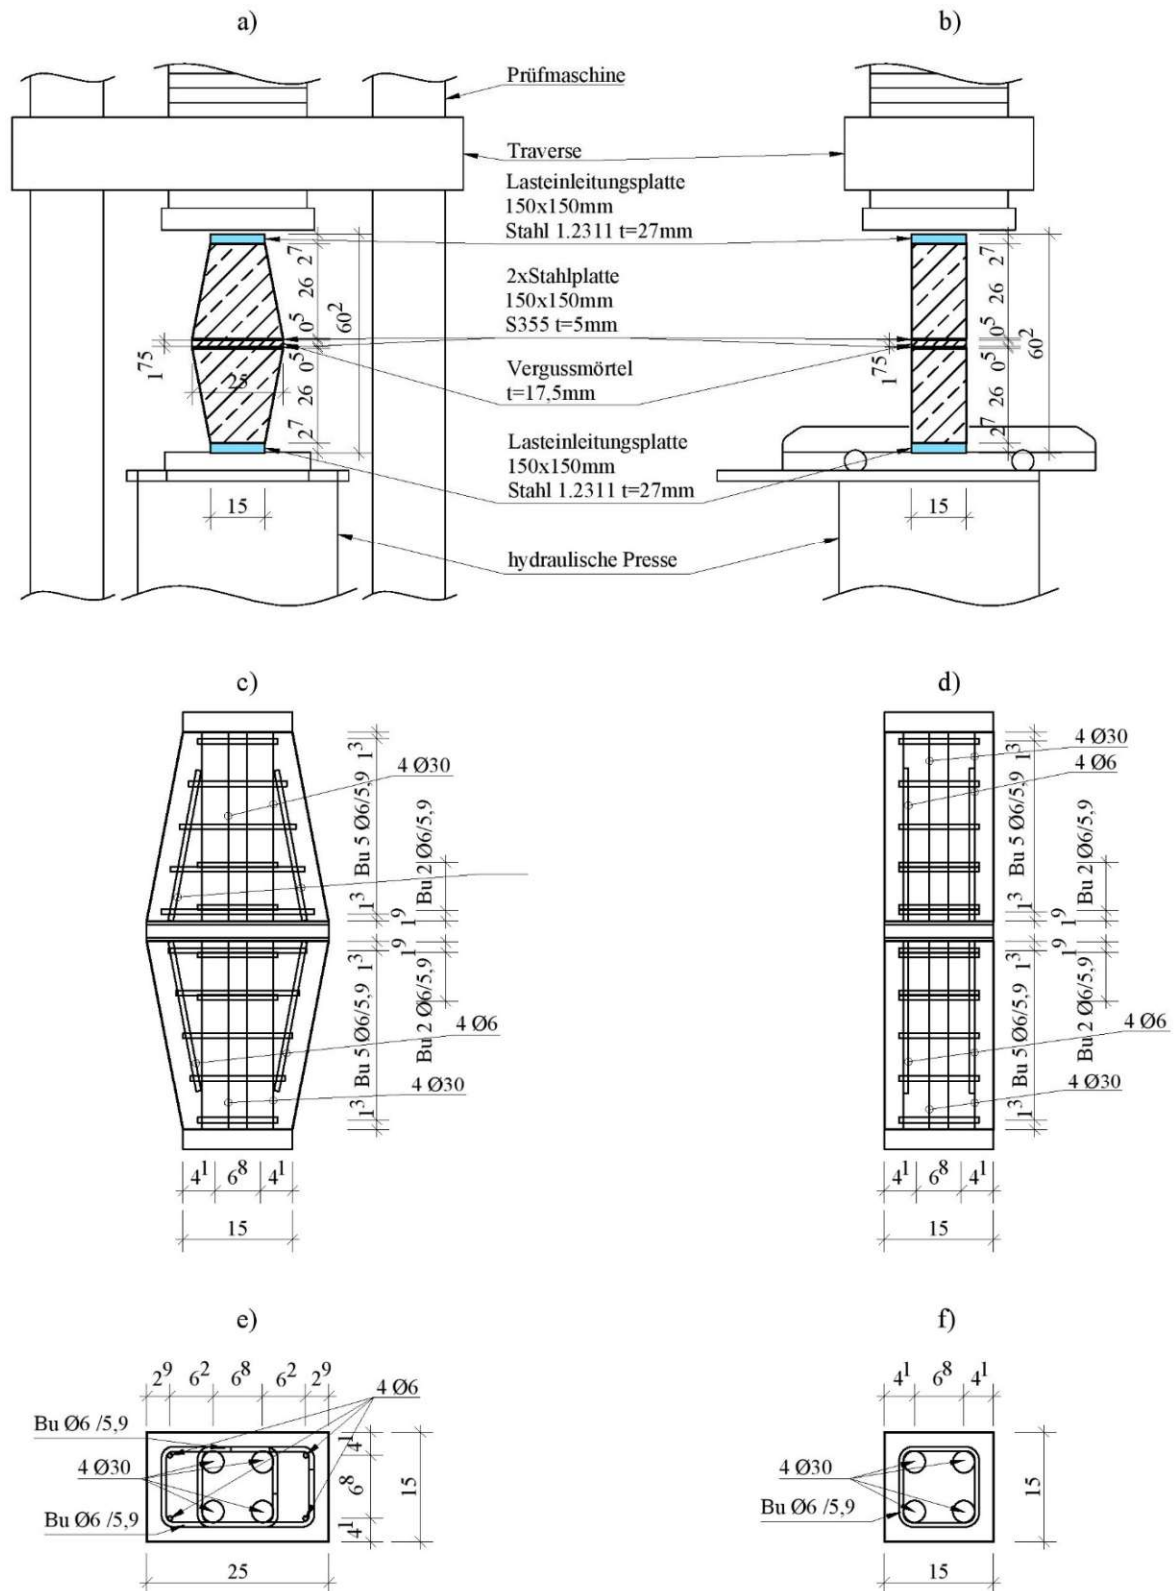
Stütze mit Stumpfstoß und Aufweitung a) Ansicht von vorne, b) Seitenansicht, c) Bewehrung im Aufriss von vorne, d) Bewehrung im Aufriss von der Seite, e) Bewehrung im Grundriss im Stoßbereich, f) Bewehrung im Grundriss im Lasteinleitungsbereich
